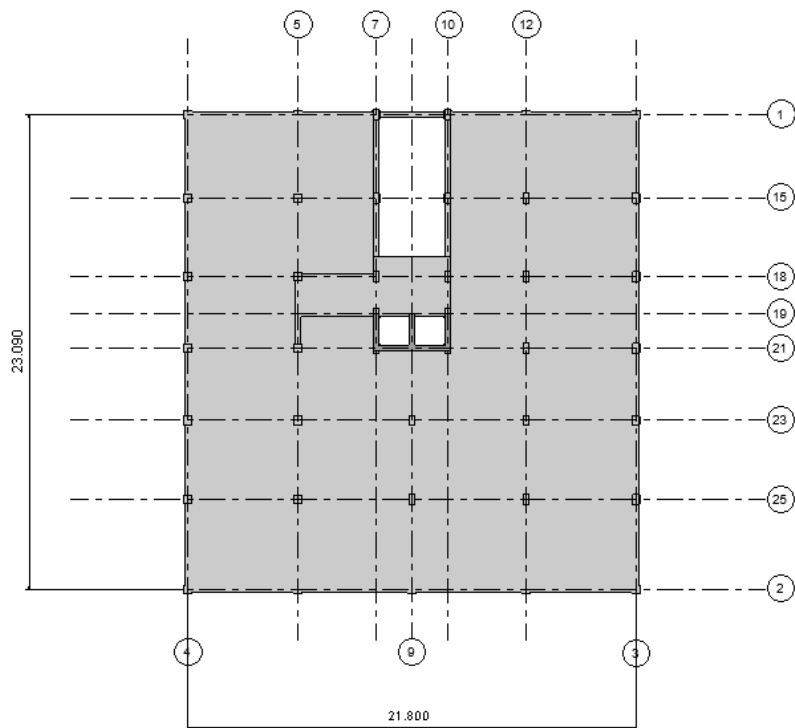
Planta estrutural do rés-do-chão da solução estrutural 2 (Revit).
